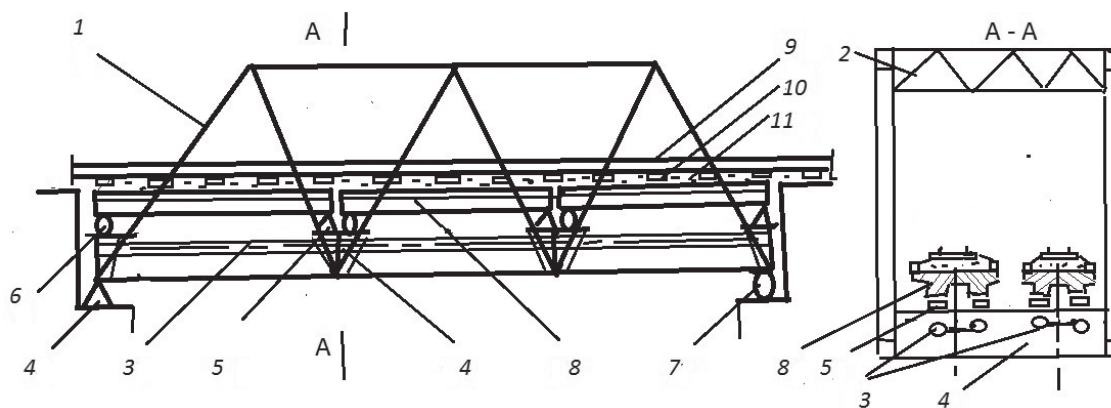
Металлическое пролетное строение с железобетонными балками и ездой на балласте: 1 – пролетное строение; 2 – поперечные связи; 3 – жесткие продольные связи; 4 – поперечная балка пролетного строения; 5 – неподвижная опорная часть железобетонной балки проезжей части; 6 – подвижная опорная часть железобетонной балки; 7 – подвижная опорная часть пролетного строения; 8 – железобетонная продольная балка проезжей части; 9 – рельс; 10 – железобетонные шпалы; 11 – балласт
